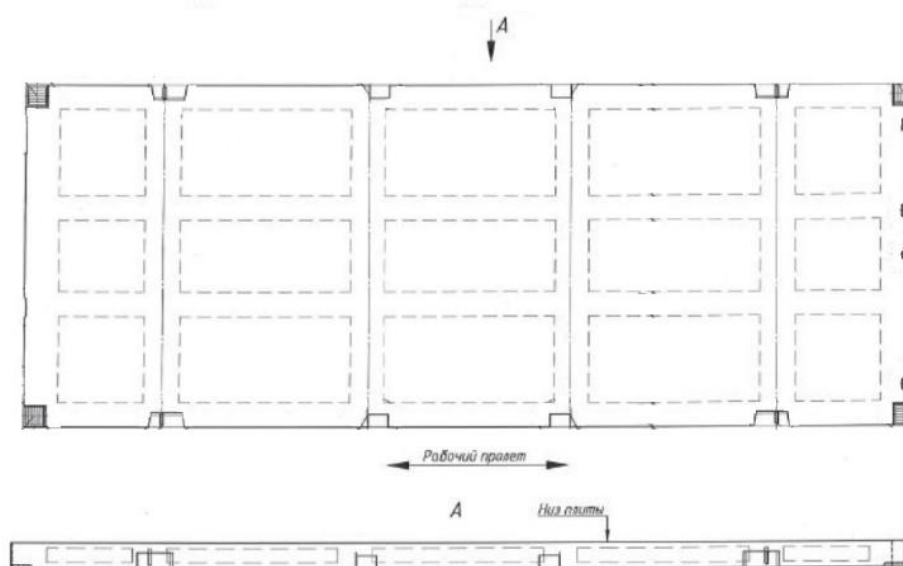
Сборная железобетонная плита перекрытия с минераловатными вкладышами
